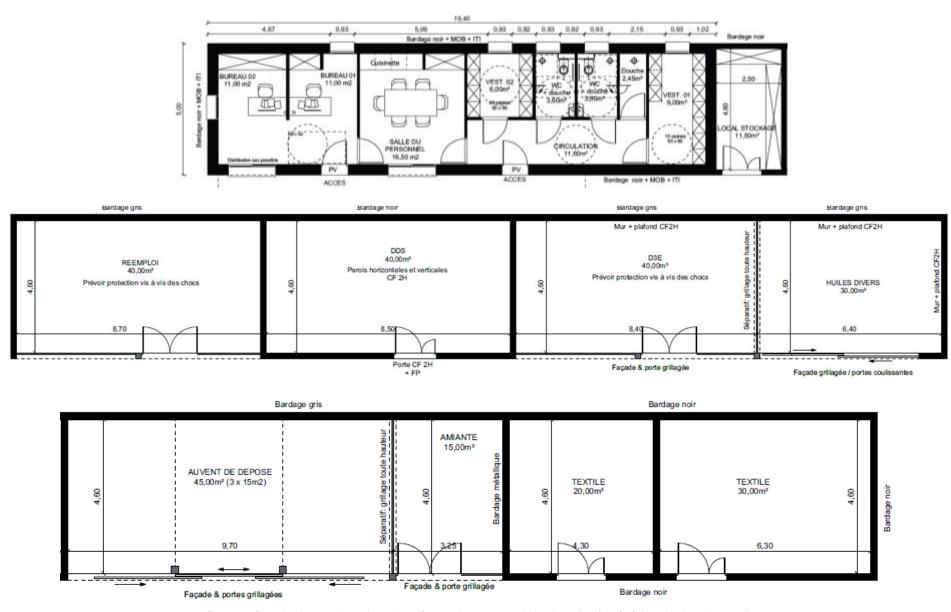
Plan des locaux de stockage des déchets dangereux et du local gardien (situés à l'est du plan de masse)
